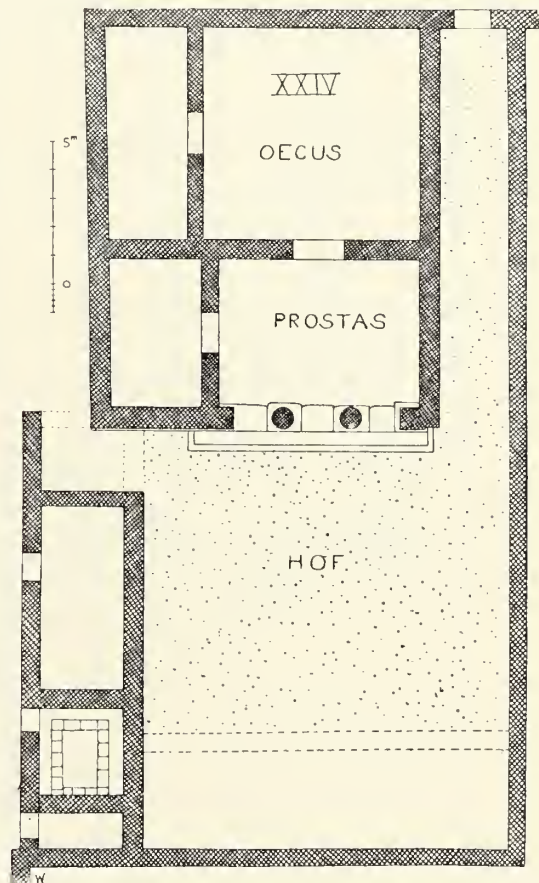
Grundriss des Hauses Nr. XXIV.
